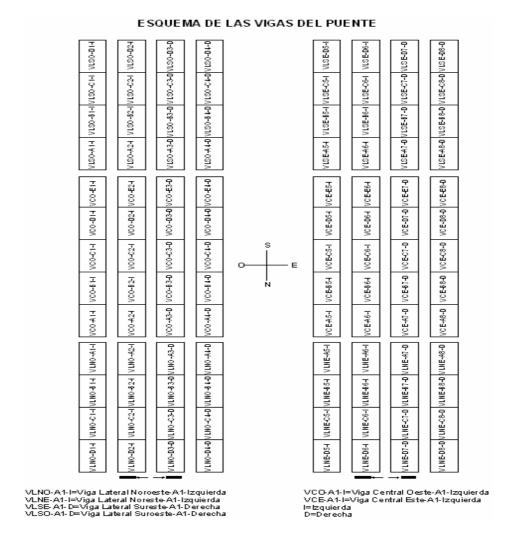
ESQUEMA DE LAS VIGAS A FABRICAR
